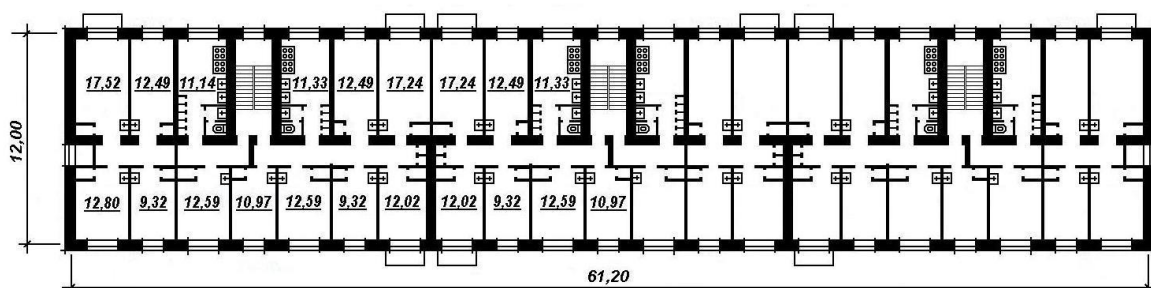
планировка 5-этажного жилого дома на 165 комнат
